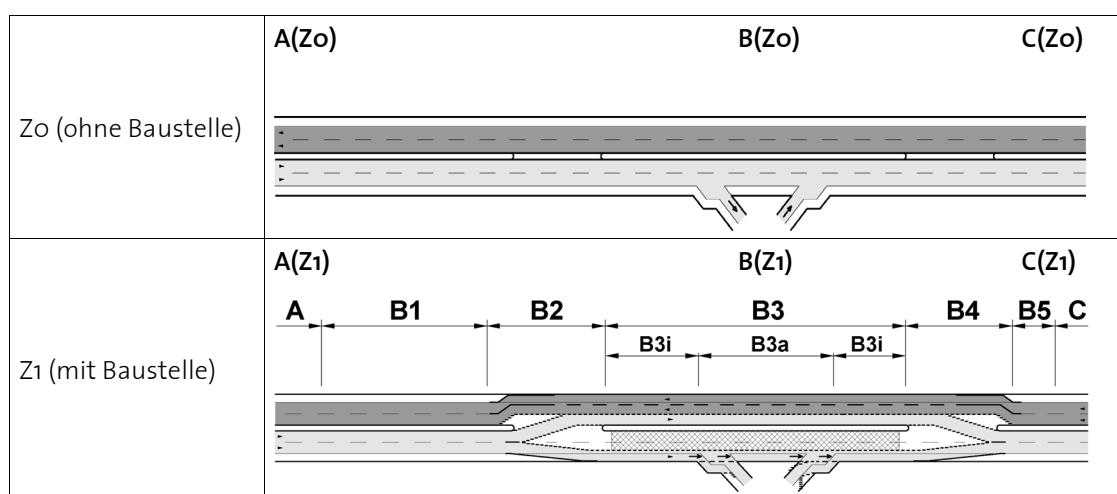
Unfalluntersuchung Vergleichsstrecke bestehend aus Vorbereich (A) und Nachbereich (C) sowie dem Baustellenabschnitt (B)
